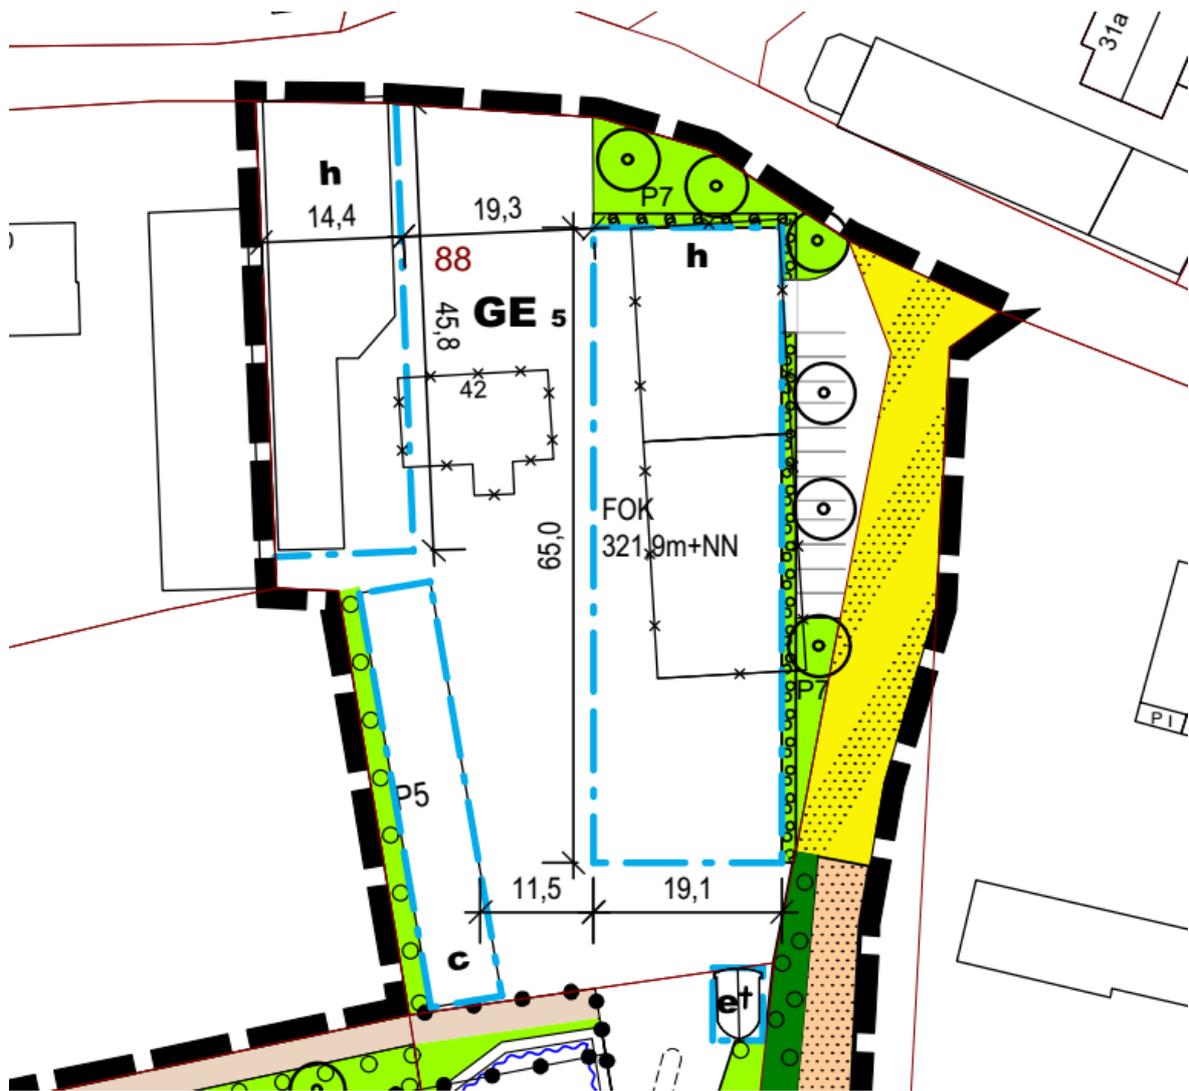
Geplante Erweiterung mit Deckblatt Nr. 6
